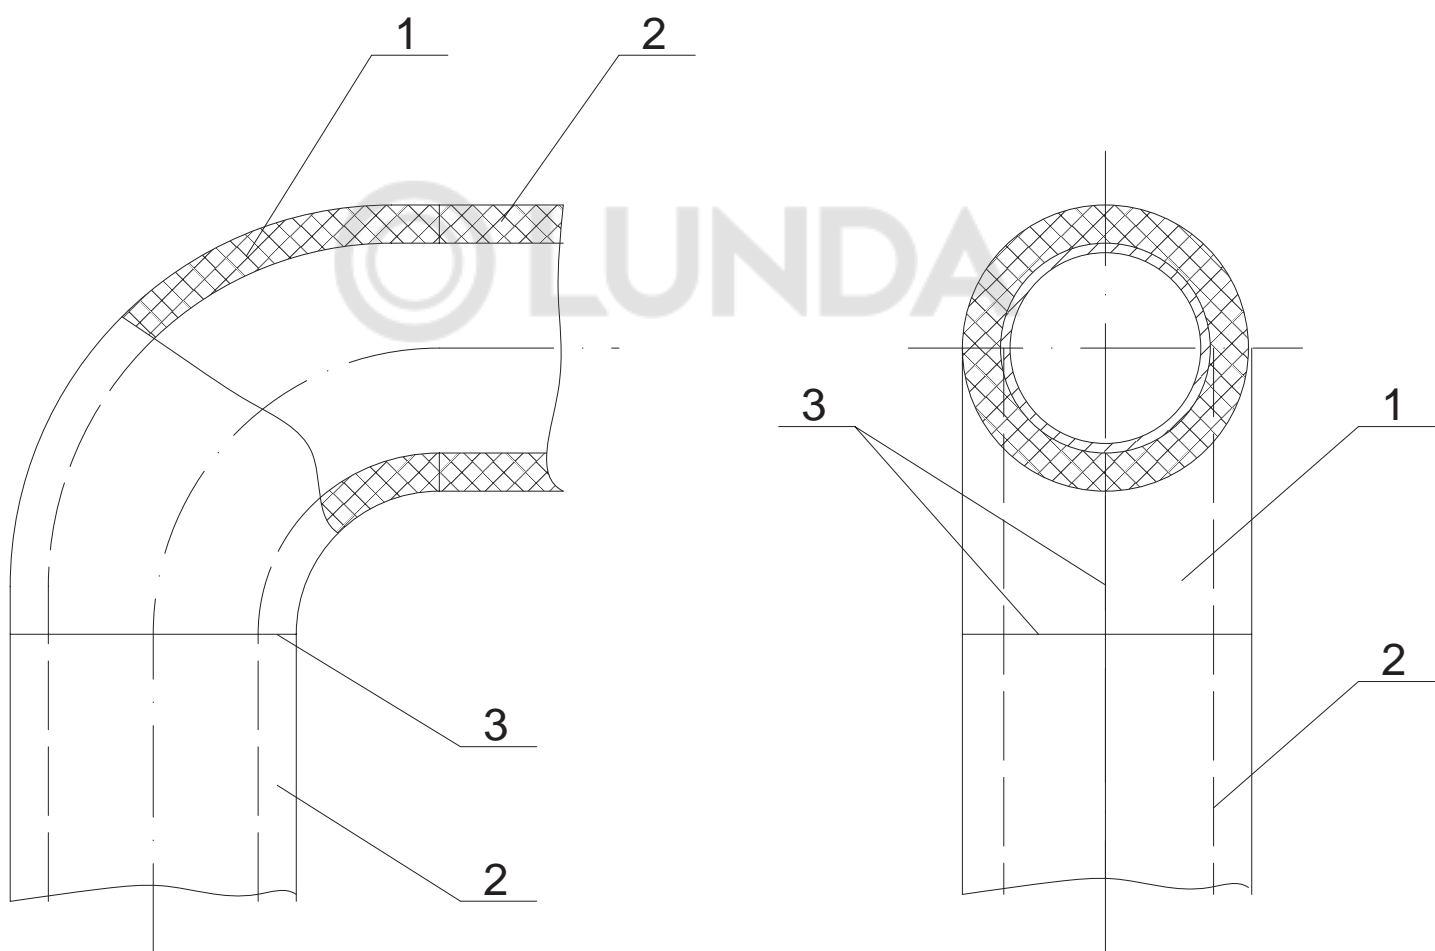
Тепловая изоляция трубопроводов изоляционными рулонами "K-Flex ECO".
